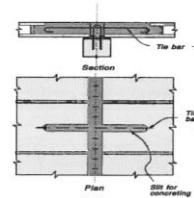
Sambungan HCS dengan Balok Ujung
